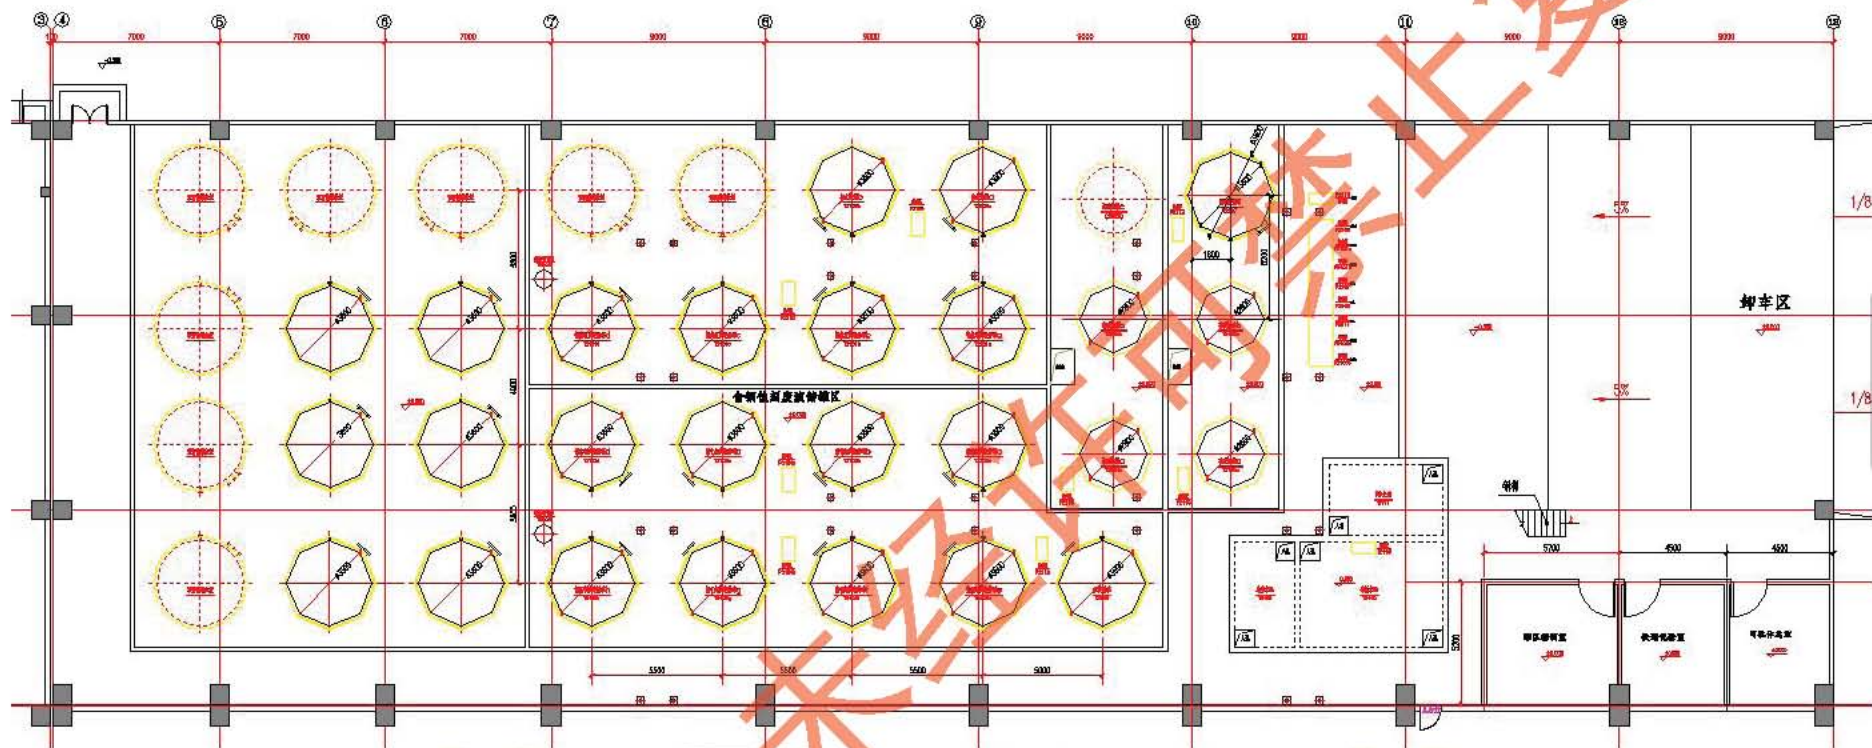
含铜蚀刻废液车间罐区平面图
